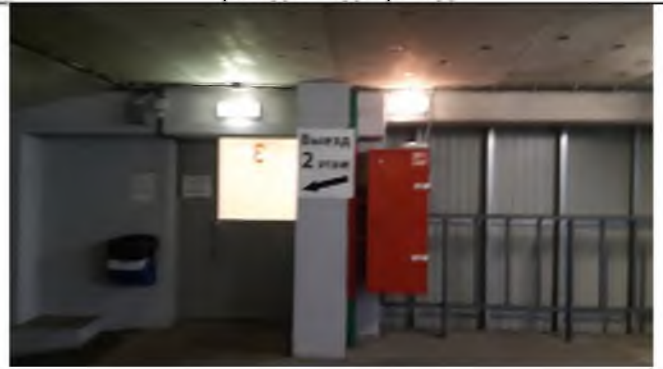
Типовое состояние помещения 19-Н (3 этаж).
